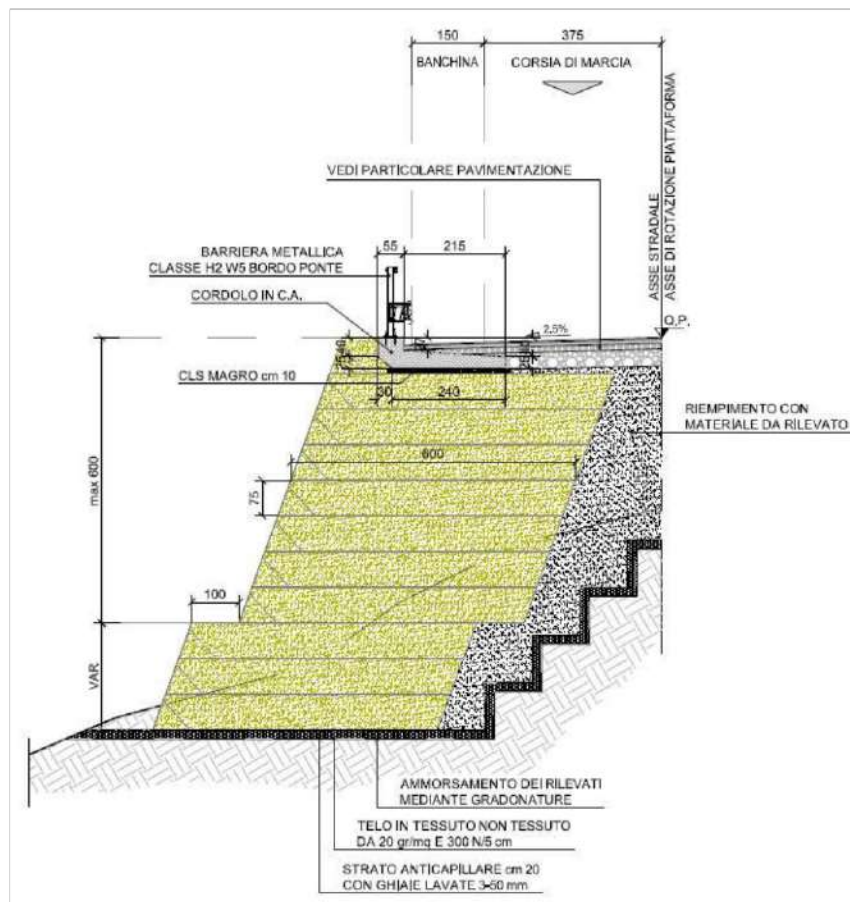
Particolare sezione stradale tipo con interventi di sostegno a valle: terre rinforzate (terramesh)
